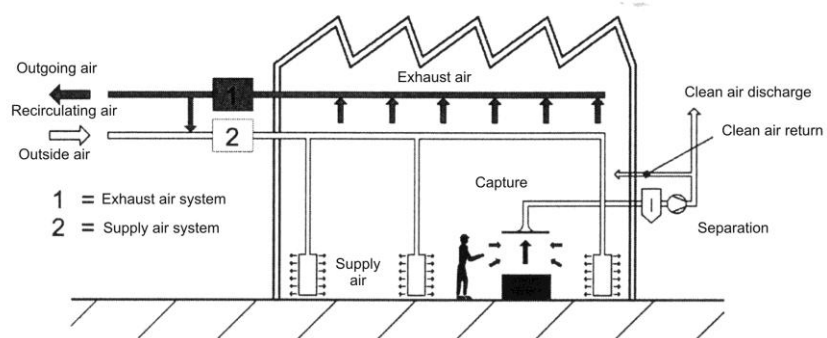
Prinzip der maschinellen Lüftung gemäß EN 12792
